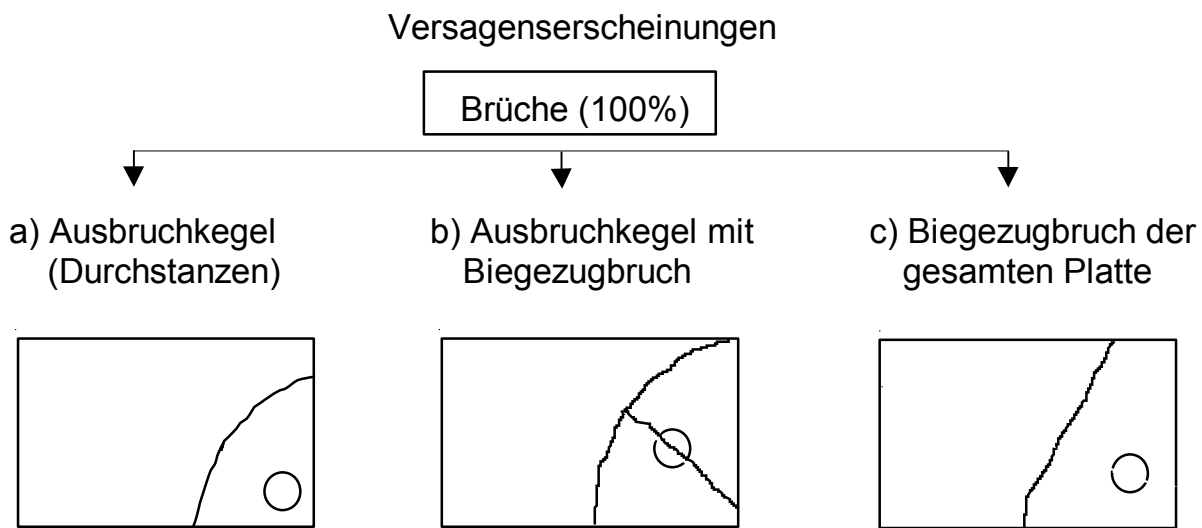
Grundrisse der Versuchskörper mit Bruchlinien an der Plattenunterseite
